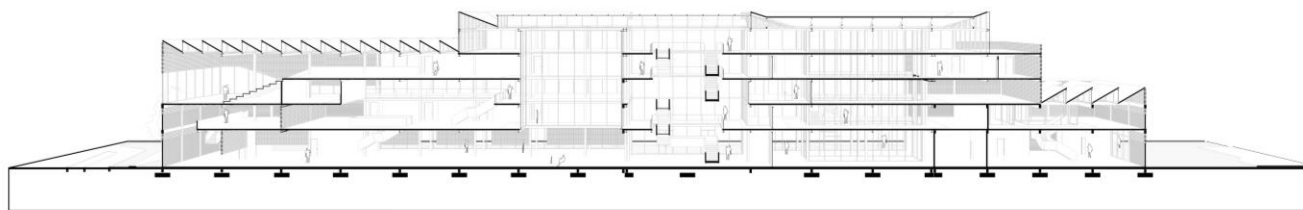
Corte fugado A-A'. Fuente: Propia.
